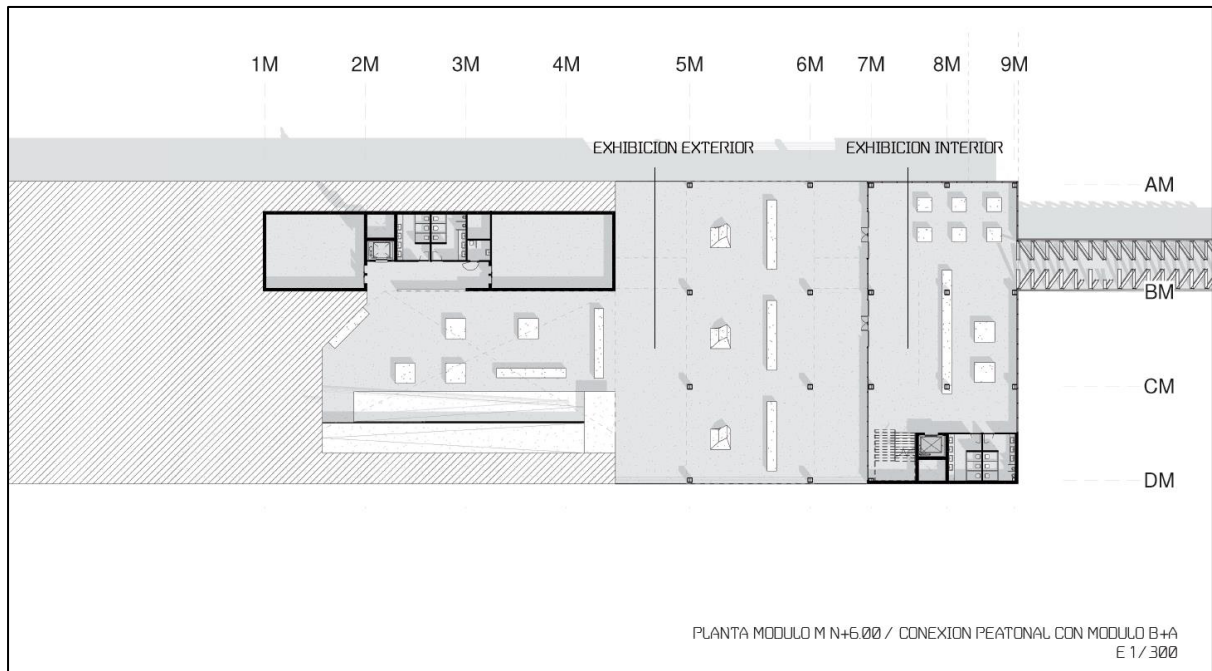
Planta N+6.00 Módulo M. Elaboración propia.
